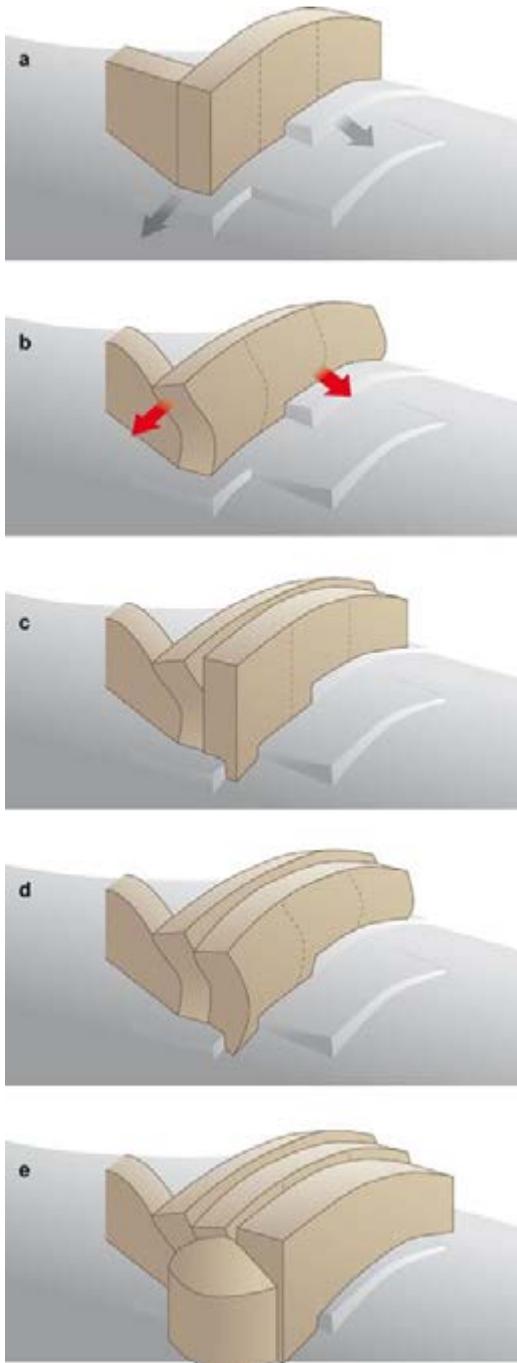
Peñalosa. Proceso de construcción y reparación de la muralla sureste mediante adosamientos sucesivos.
